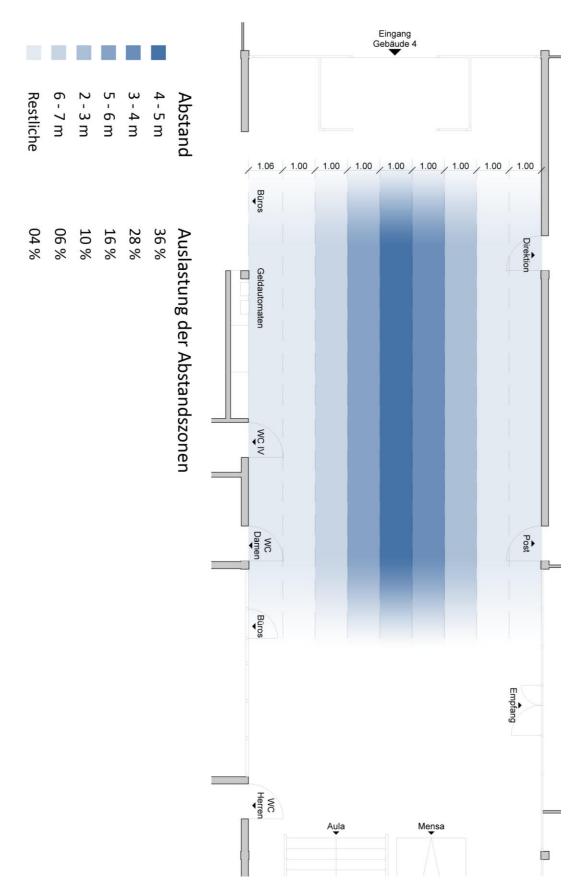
Auslastung der Abstandszonen, Grundriss Verwaltungsgebäude
